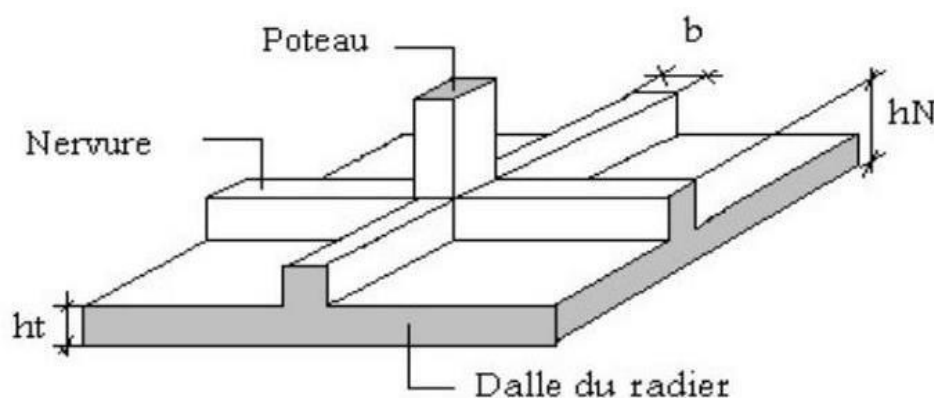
disposition des nervures par rapport au radier et aux poteaux
